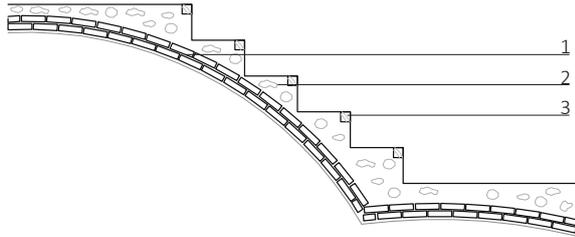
Detalle escalera bóveda tabicada Fuente: propia
